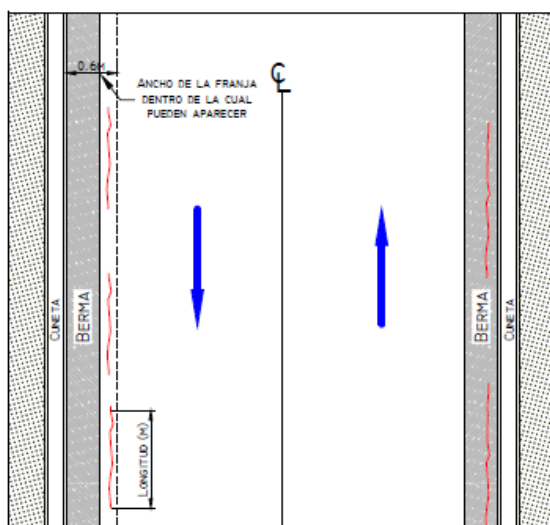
Fisuras de borde sobre pavimento asfáltico existente.
